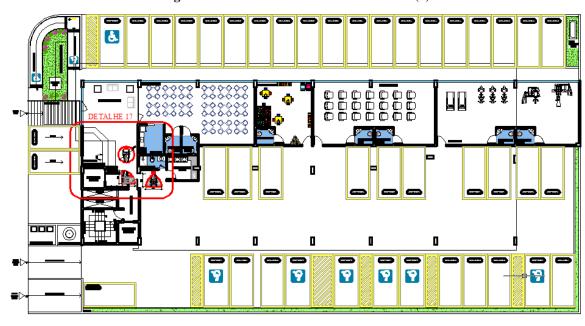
Planta Baixa - Pavimento térreo (5)
